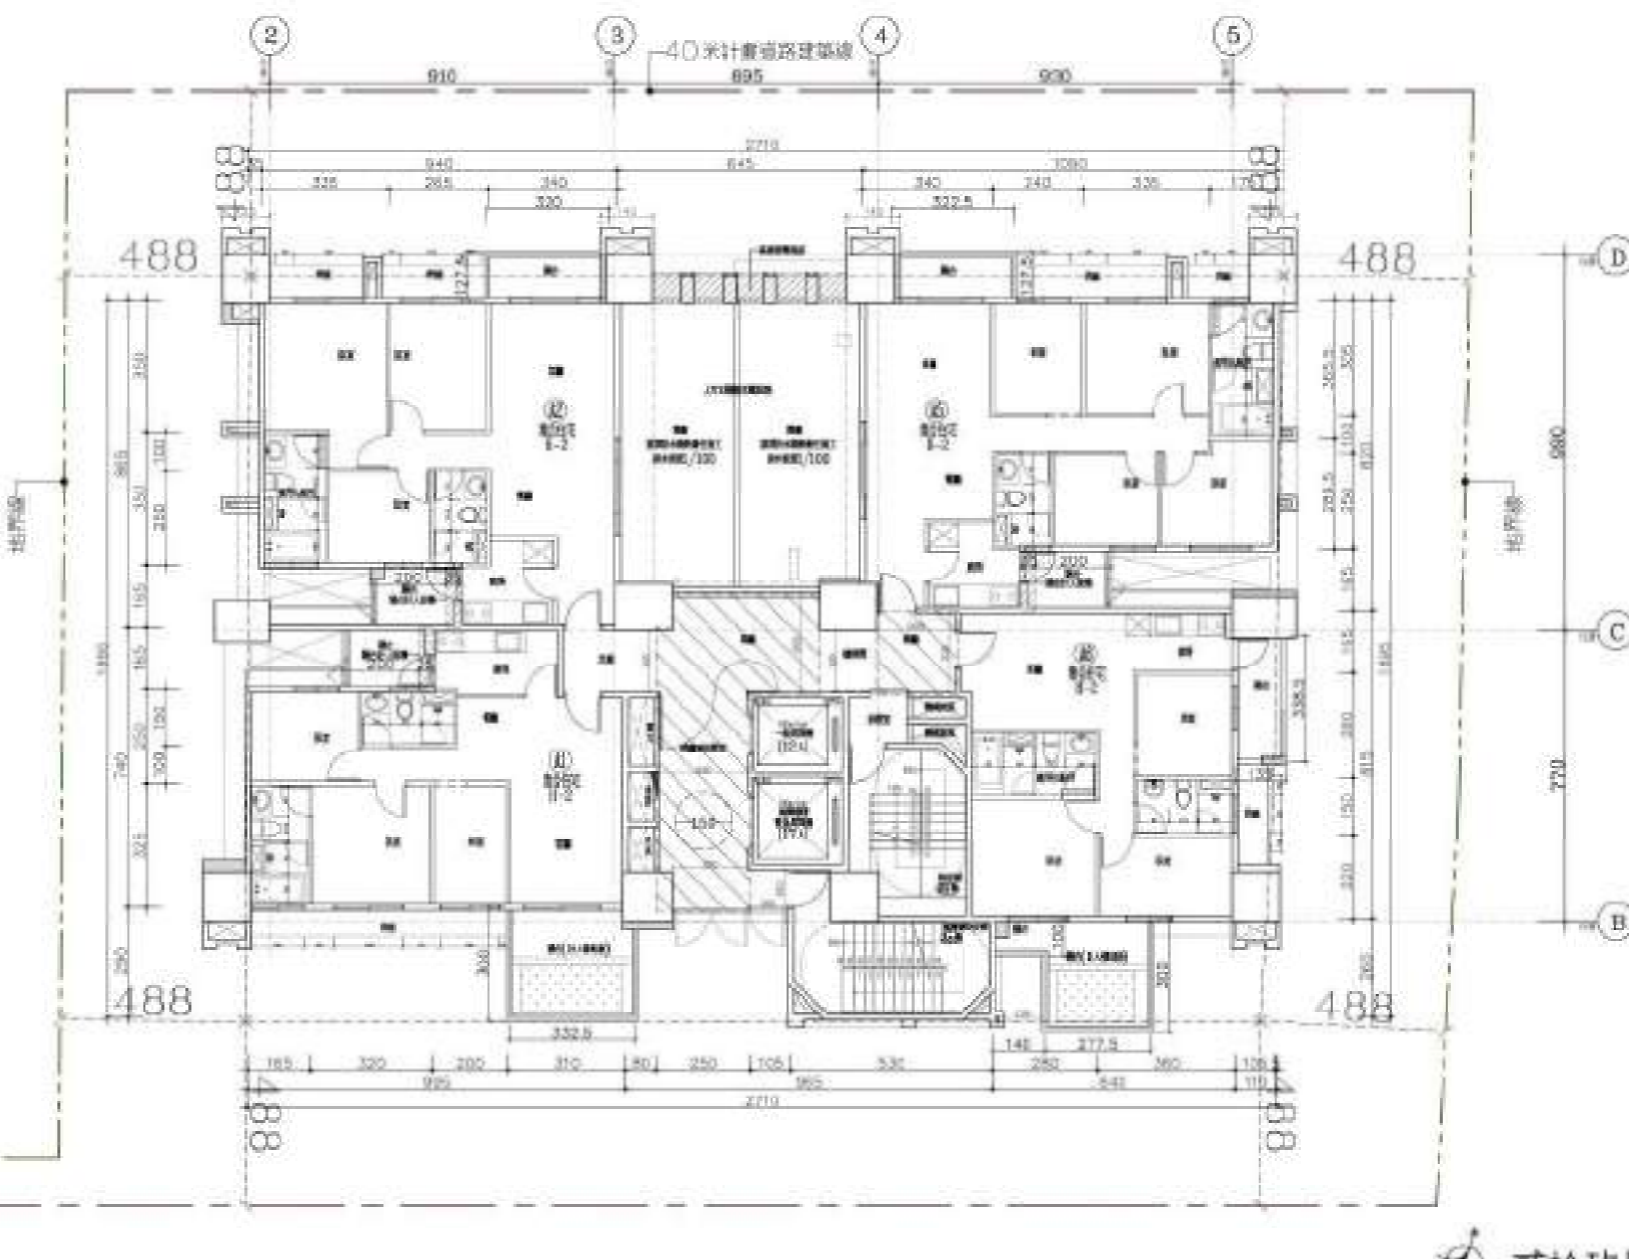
地上 29 層平面圖 (比例尺 1/200)
